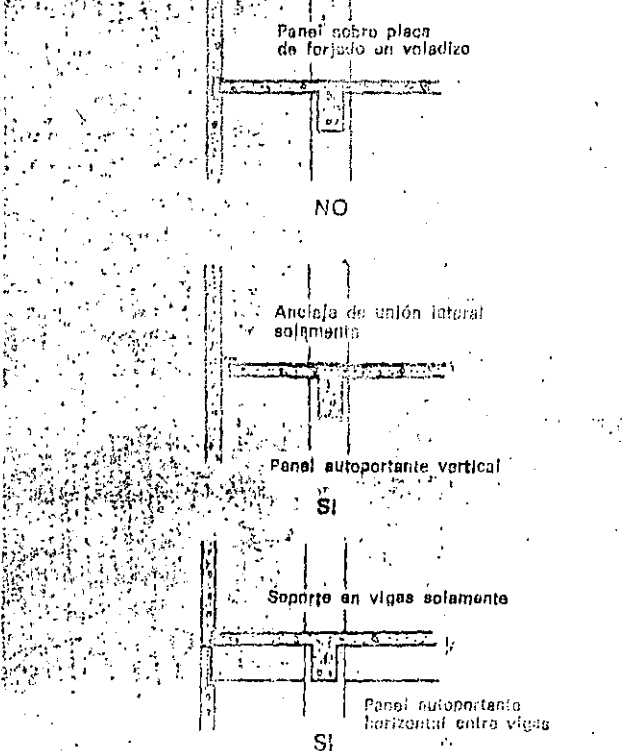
UNIONES PARA LOS PANELES EN HORMIGON PREFABRICADO DE SOPORTE DE MUROS
